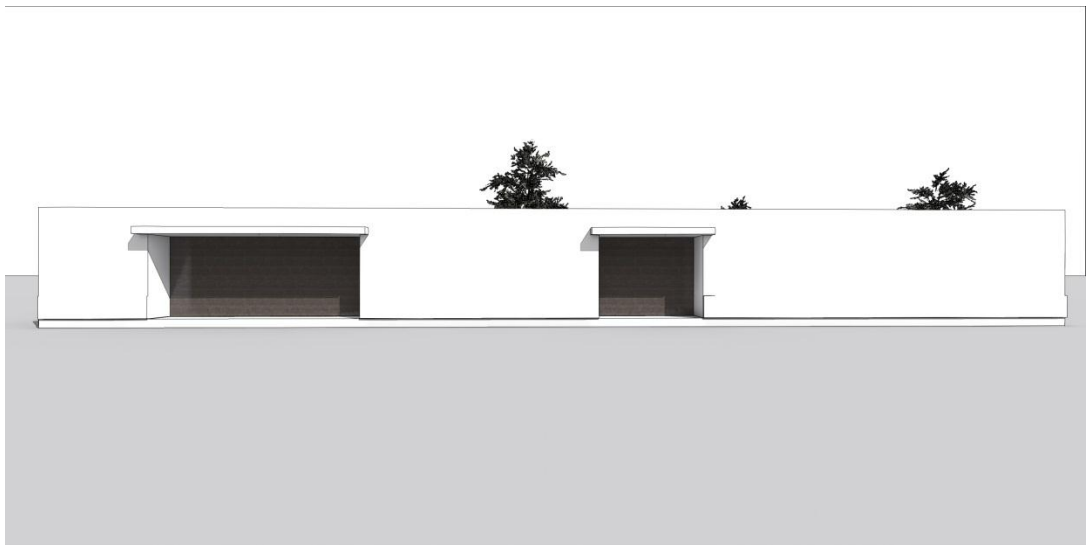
Vista 3d - fachada principal. Fuente: Elaboración propia.
